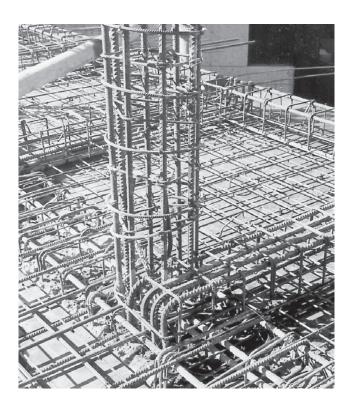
Armaduras en el hormigón armado. (Gentileza de Eduardo Effa).
